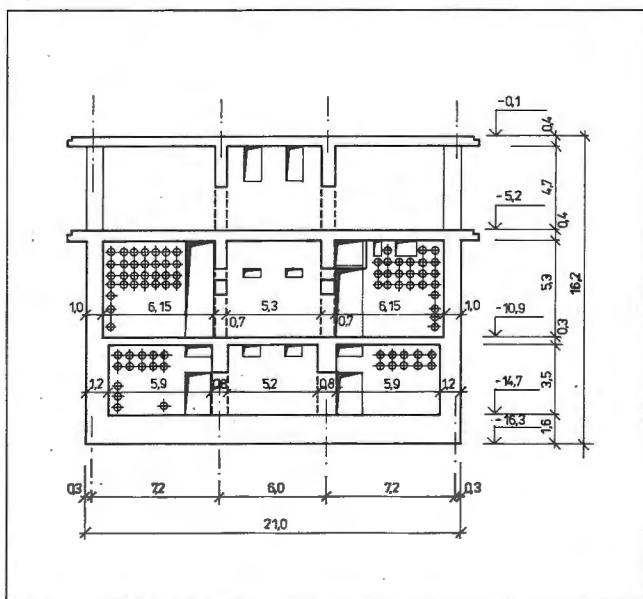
Tvar konstrukce druhého podzemního podlaží
